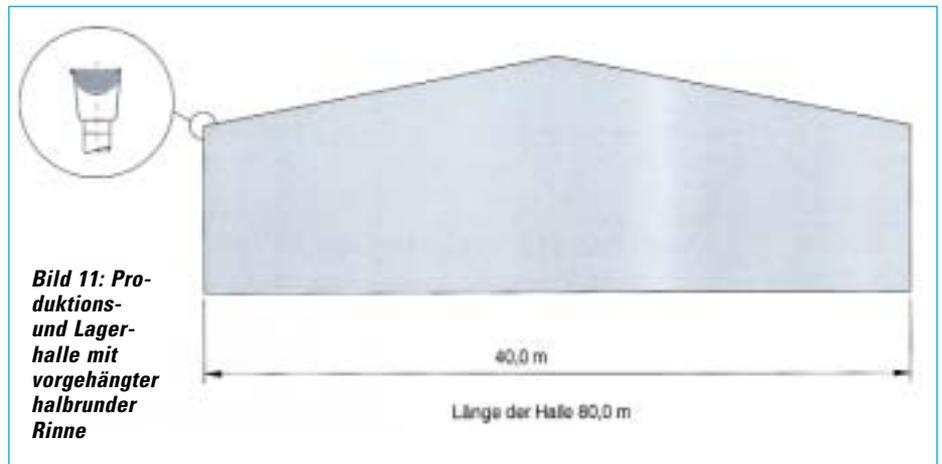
Produktions- und Lagerhalle mit vorgehängter halbrunder Rinne
